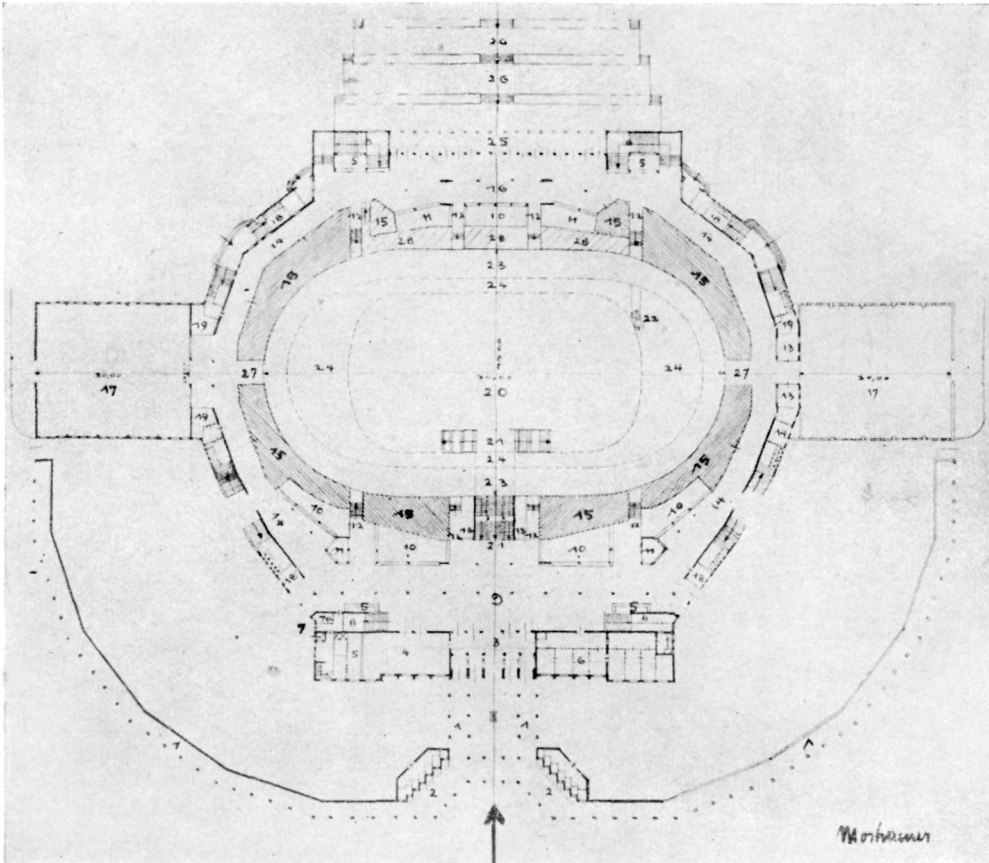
Westfalenhalle Dortmund. Erdgeschoß-Grundriß 1:500
